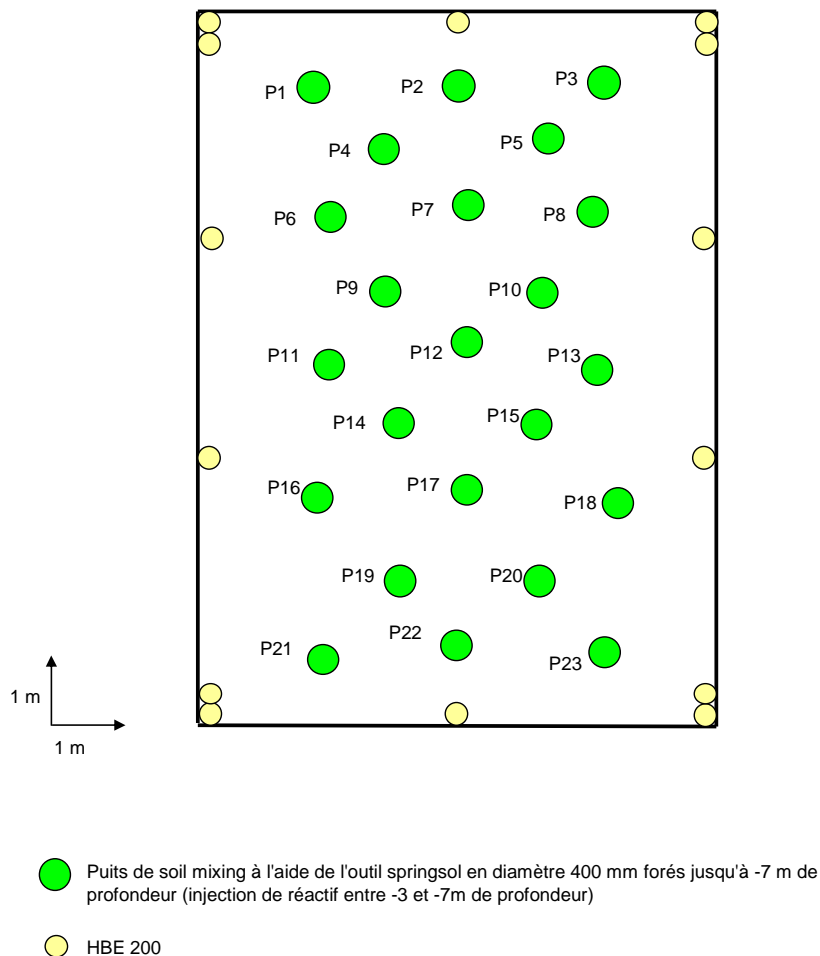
Plan d'implantation des plots de malaxage sur la zone de travaux de l'ancien site de Knorr Bremse
